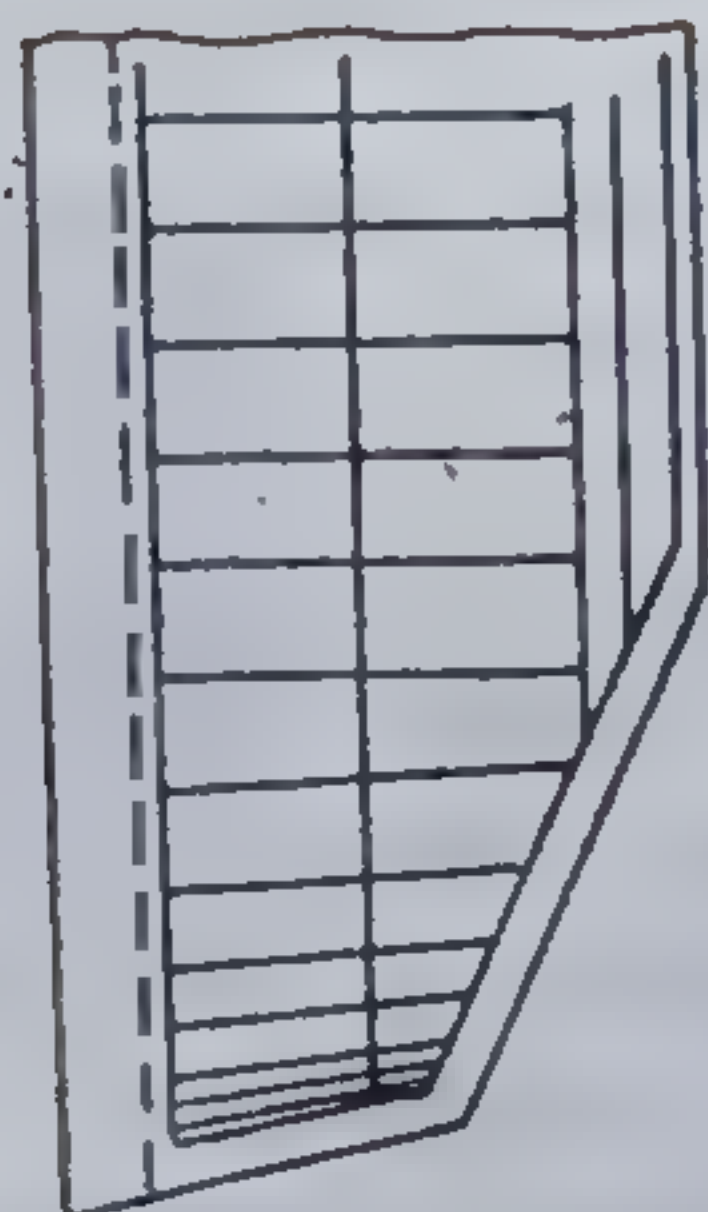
Detaliu de vîrf al palplanșei din beton armat.
